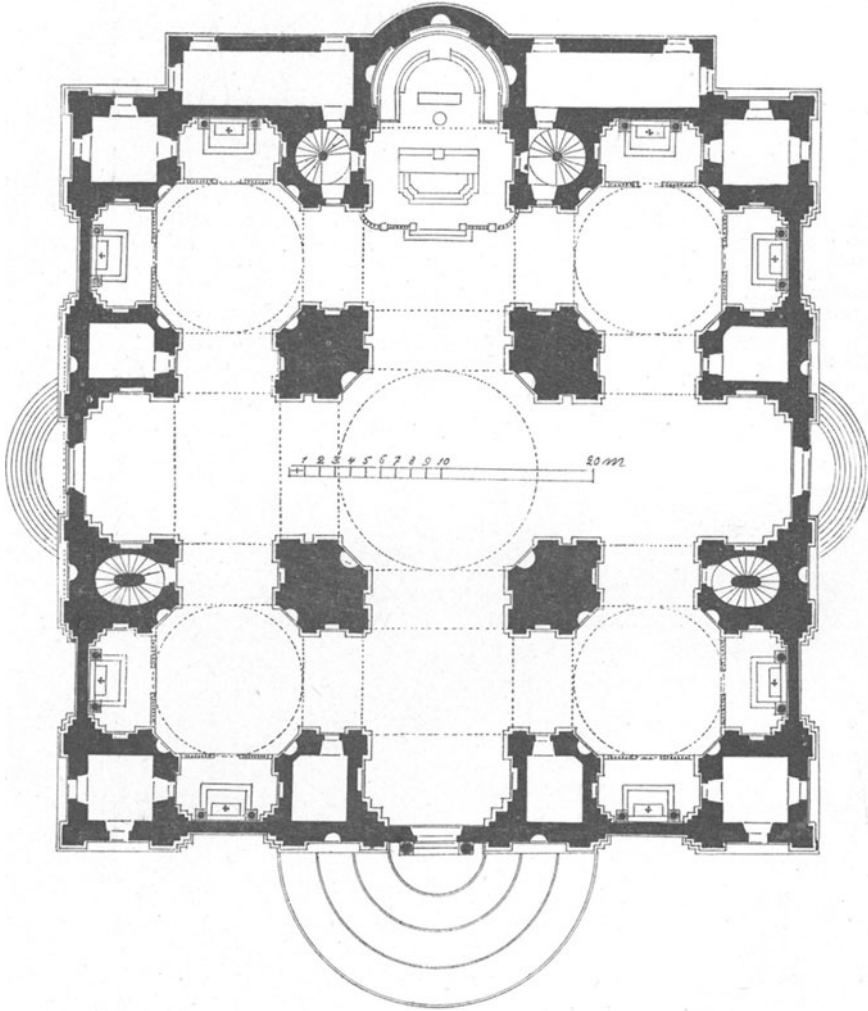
Kirche S. M. di Carignano. Grundriss.
